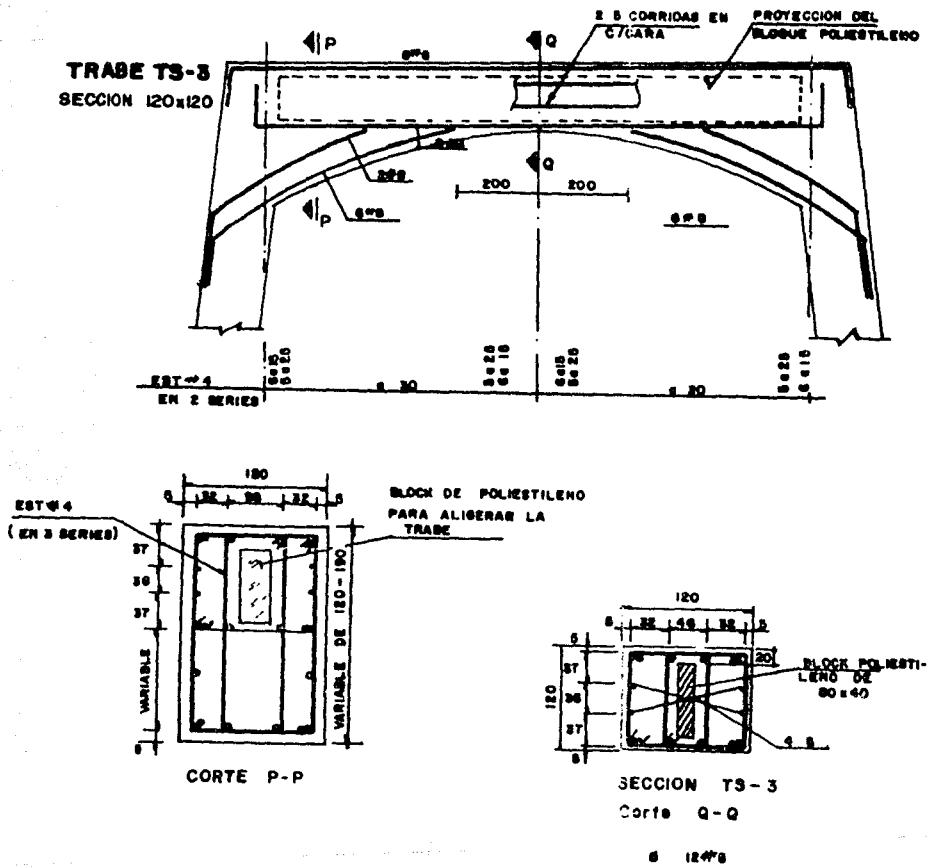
ARMADO PARA LA TRABE DE MASTILES.
